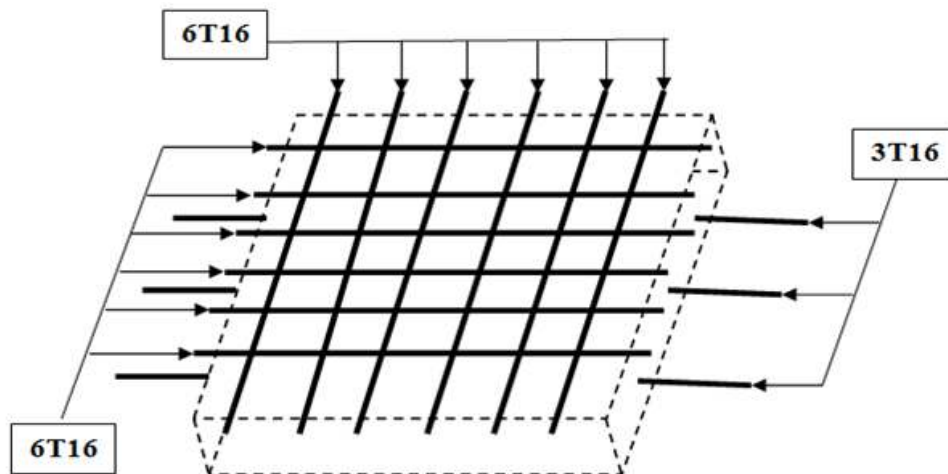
Ferrailage de 1 m de la dalle pleine
